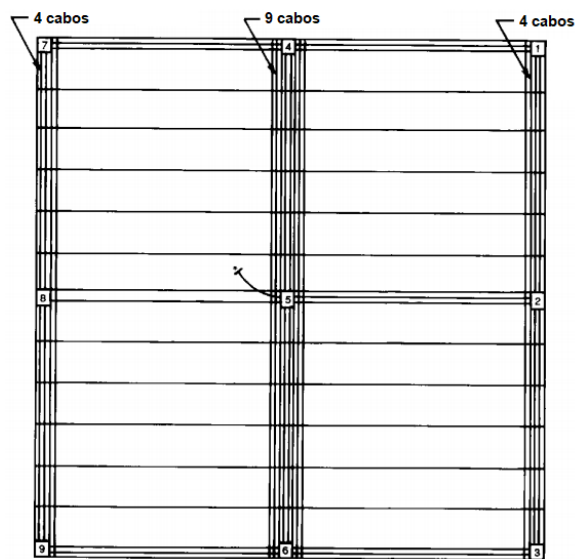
Distribuição dos cabos em planta (Adaptado de ACI 423.3R-96).
